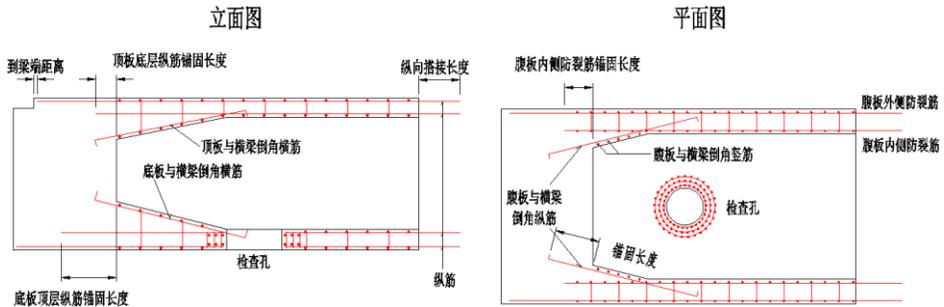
边跨现浇段钢筋-纵筋直线绘制示意图
